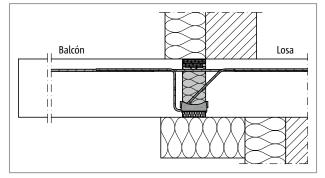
Schöck Isokorb® T tipo K: Conexión para losa apoyada indirectamente y SATE
